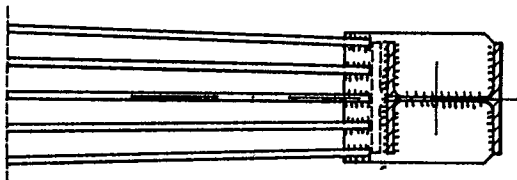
Empotramiento elástico de vigas mixtas con soportes metálicos.
